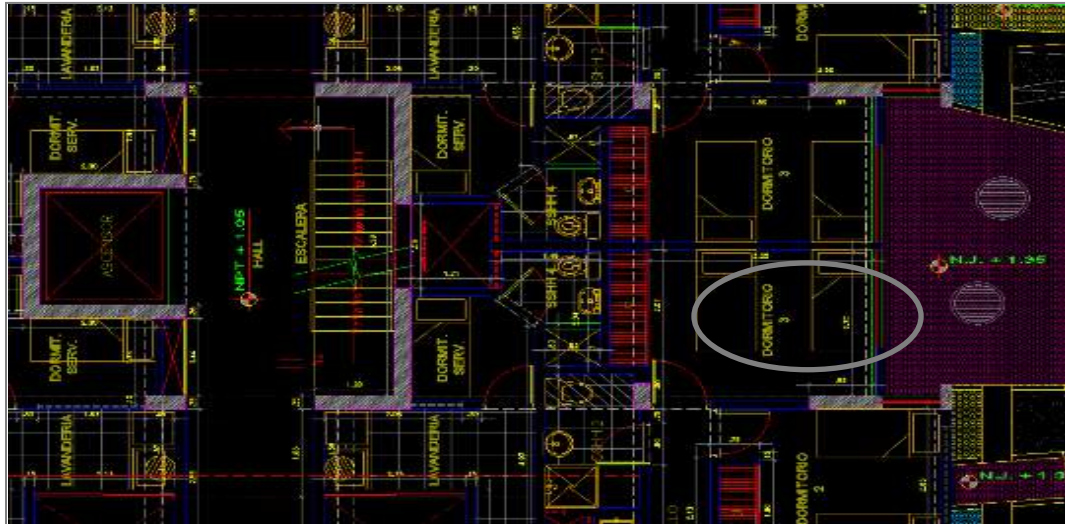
Plano A – 02: El mismo elemento tiene dimensiones de 0.25x0.95
